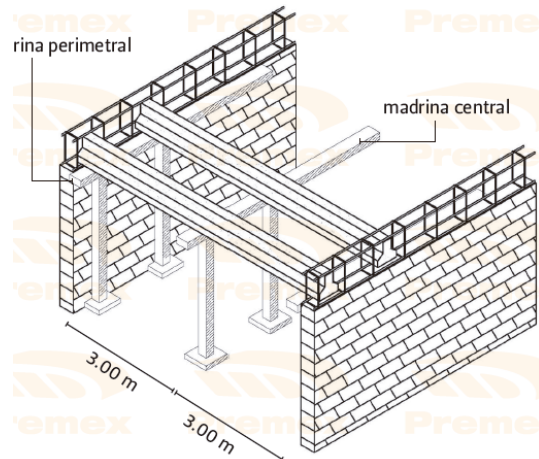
Esquema de colocación de vigueta. Fuente. Manual de PREMEX.
